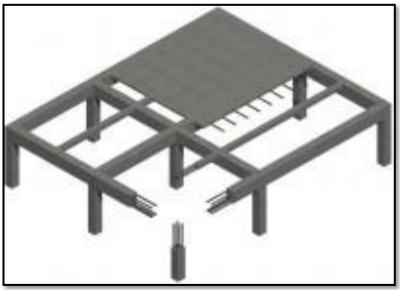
principe poteau poutre dalle en béton, source site web : http://www.explorations-architecturales.com/data/new/fichePrint_95.htm
